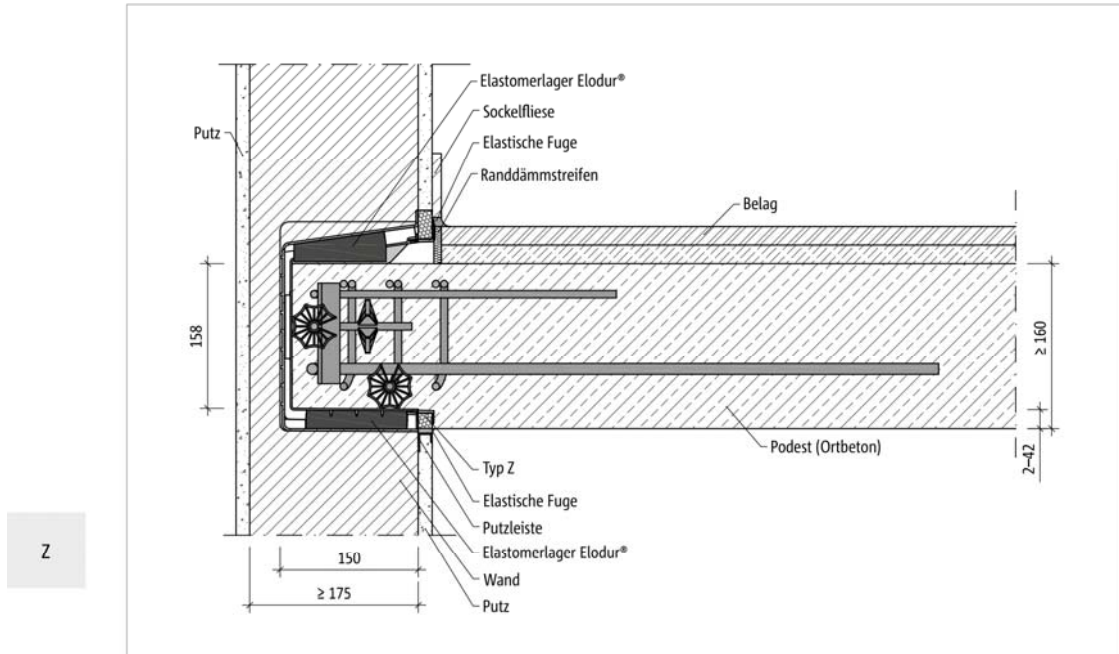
Schöck Tronsole® Typ Z-V+V-T: Einbauschnitt Ortbetonpodest
